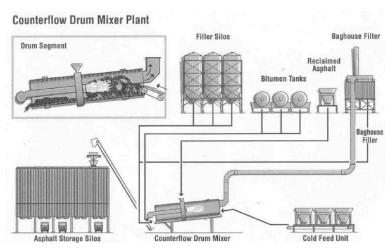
Planta de mezclado continua de RAP en caliente con contraflujo. (European Asphalt Pavement Association, 2005)
